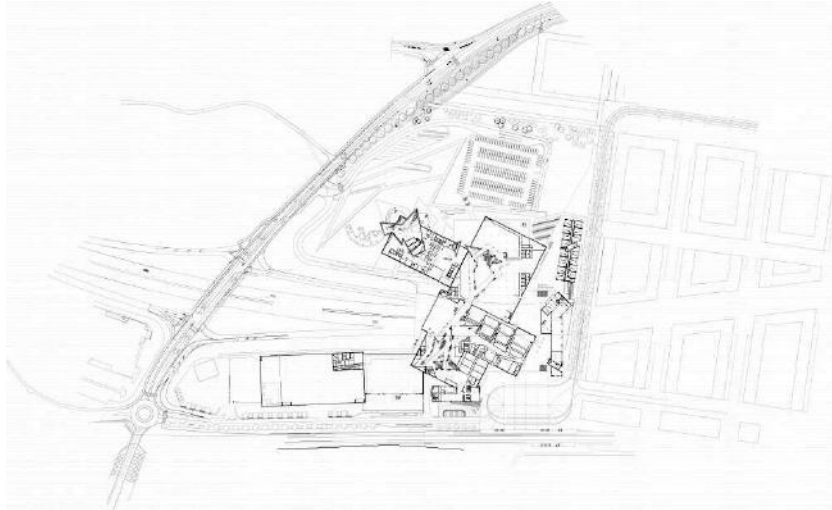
Plan de centre commercial westside - Source : archdaily.
